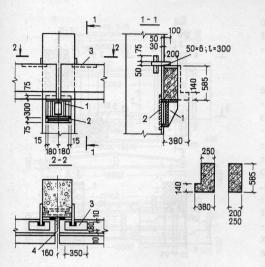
Крепление обвязочных балок к железобетонной колонне
